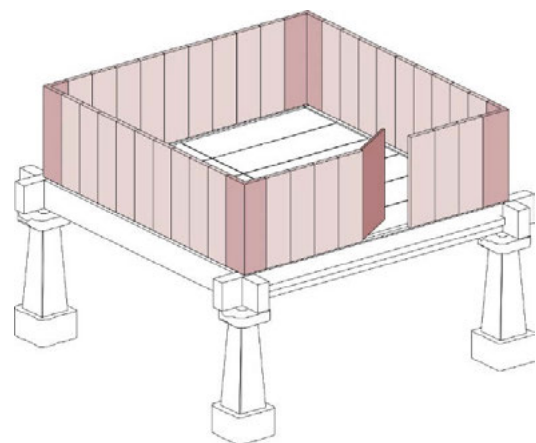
Fase 4 - Colocación de las colondras, engüelgos y puerta
